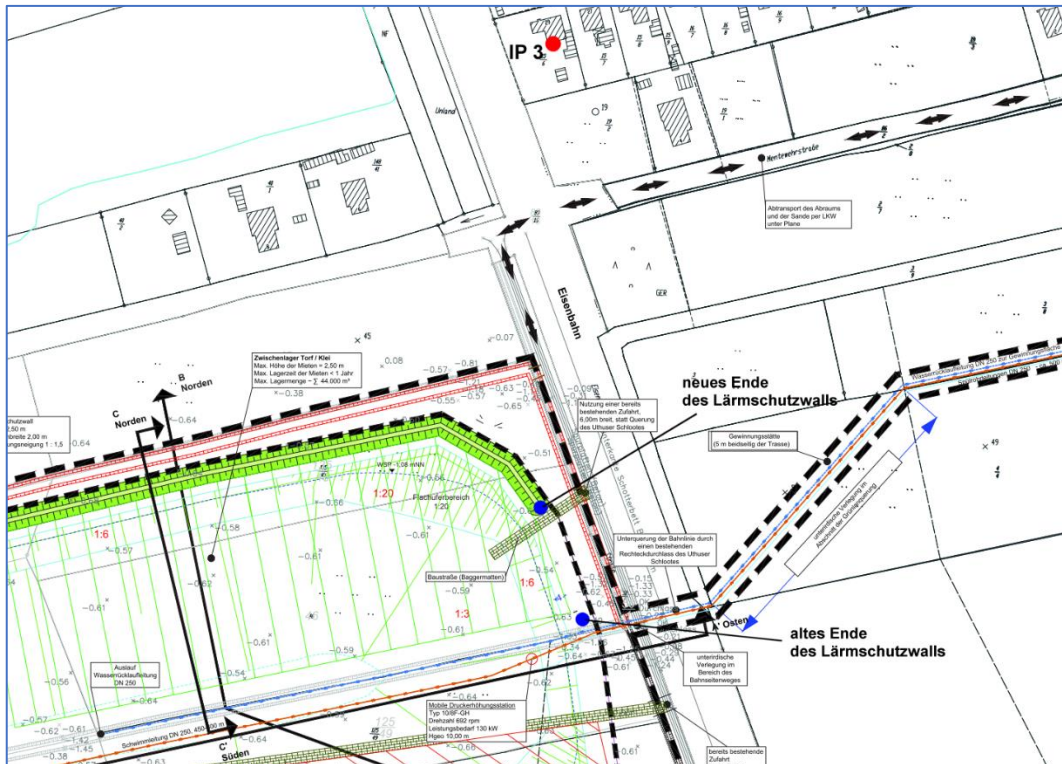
Planausschnitt mit dem verkürzten Lärmschutzwall und dem Immissionsort IP 3
